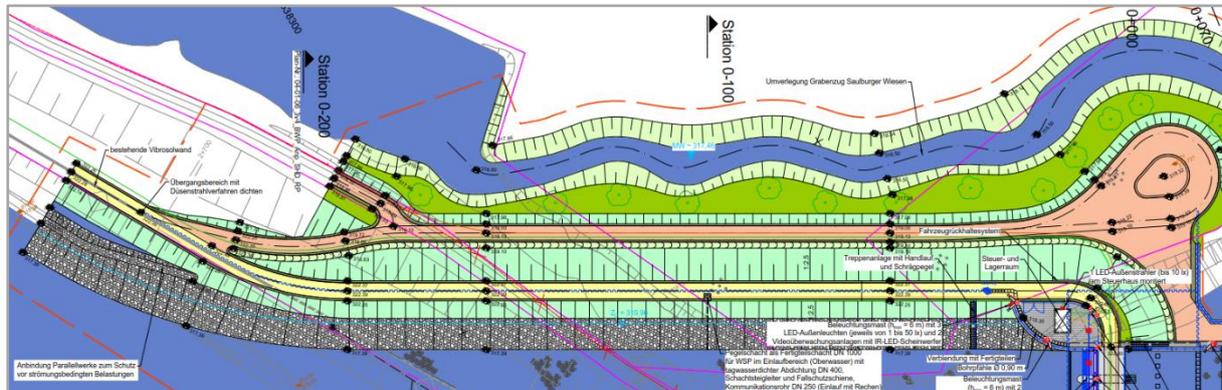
Ersatzneubau Stauhaltungsdamm, Ausschnitt Detaillageplan (aus Plan 04-01-01)
